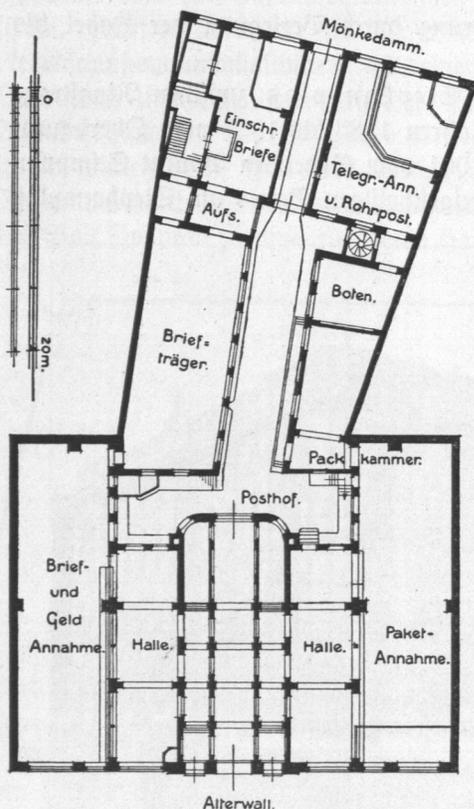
Postschekamt am Altenwall, Erdgeschoss, Grundriß.
